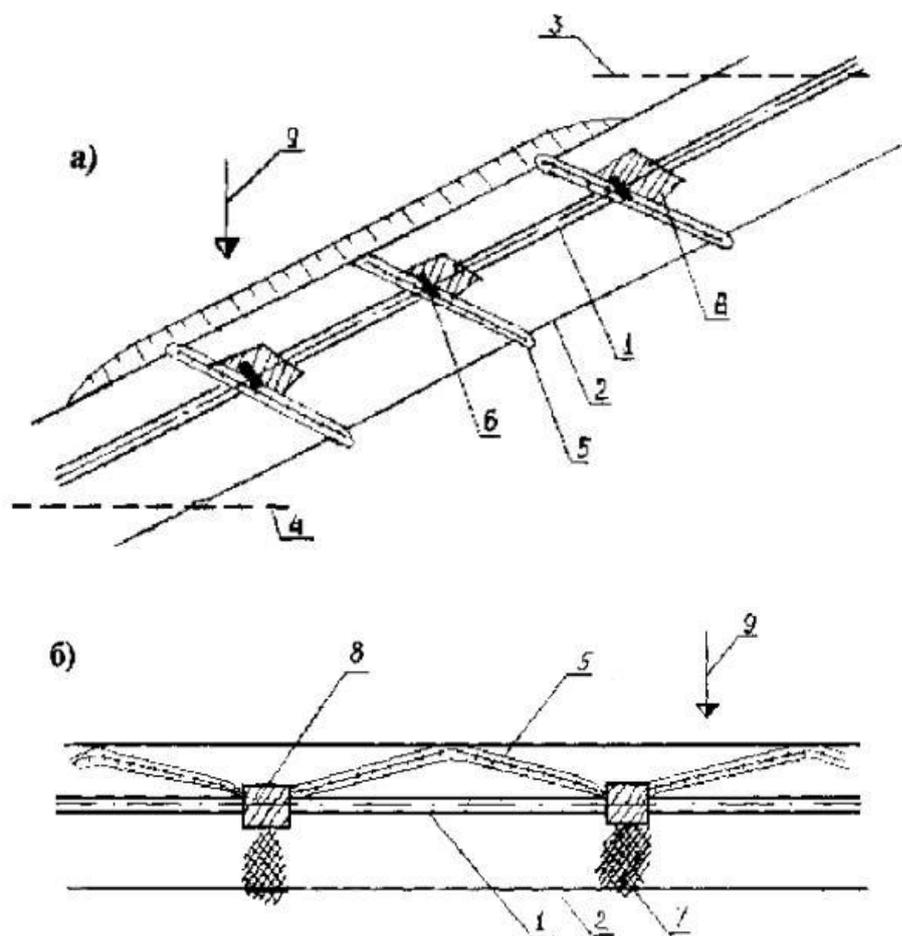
Расположение открытого дренажа на косогоре и на поперечном склоне (план): а) на косогоре; б) на поперечном склоне; 1 - валик засыпки трубопровода; 2 - границы строительной полосы газопровода; 3 – верх склона; 4 - низ склона; 5 - водоотводящие валики; 6 – траншейны перемычки; 7 - участки поверхностного закрепления грунта; 8 – надтраншейные водопропуски; 9 - направление уклона местности
